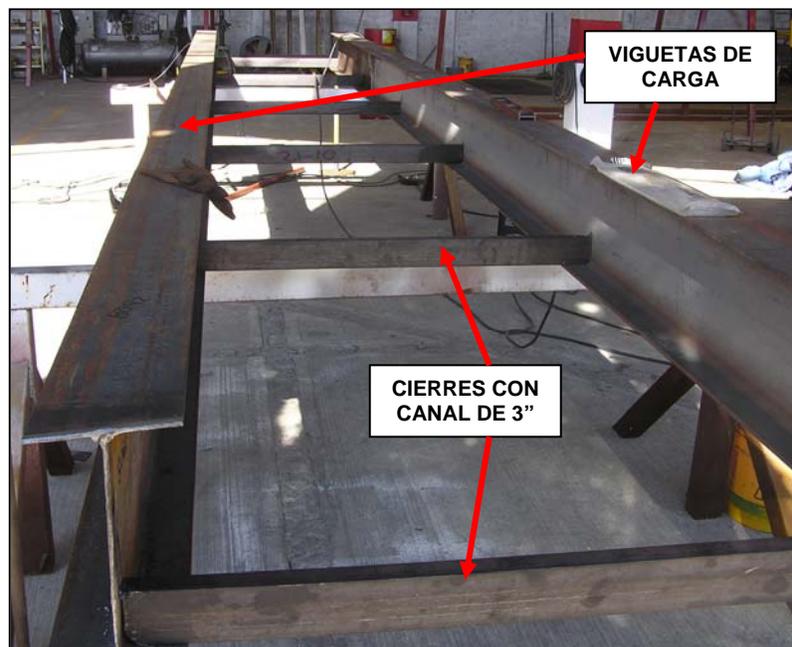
Detalle de cierres con canal de 3"* >>>
